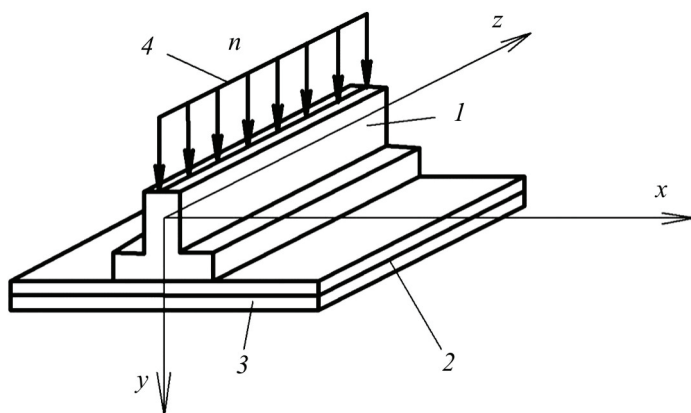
Расчетная схема: 1 – ленточный фундамент; 2 – слой геоимплантатов; 3 – слой зоны уплотнения грунта; 4 – распределенная нагрузка на фундамент
